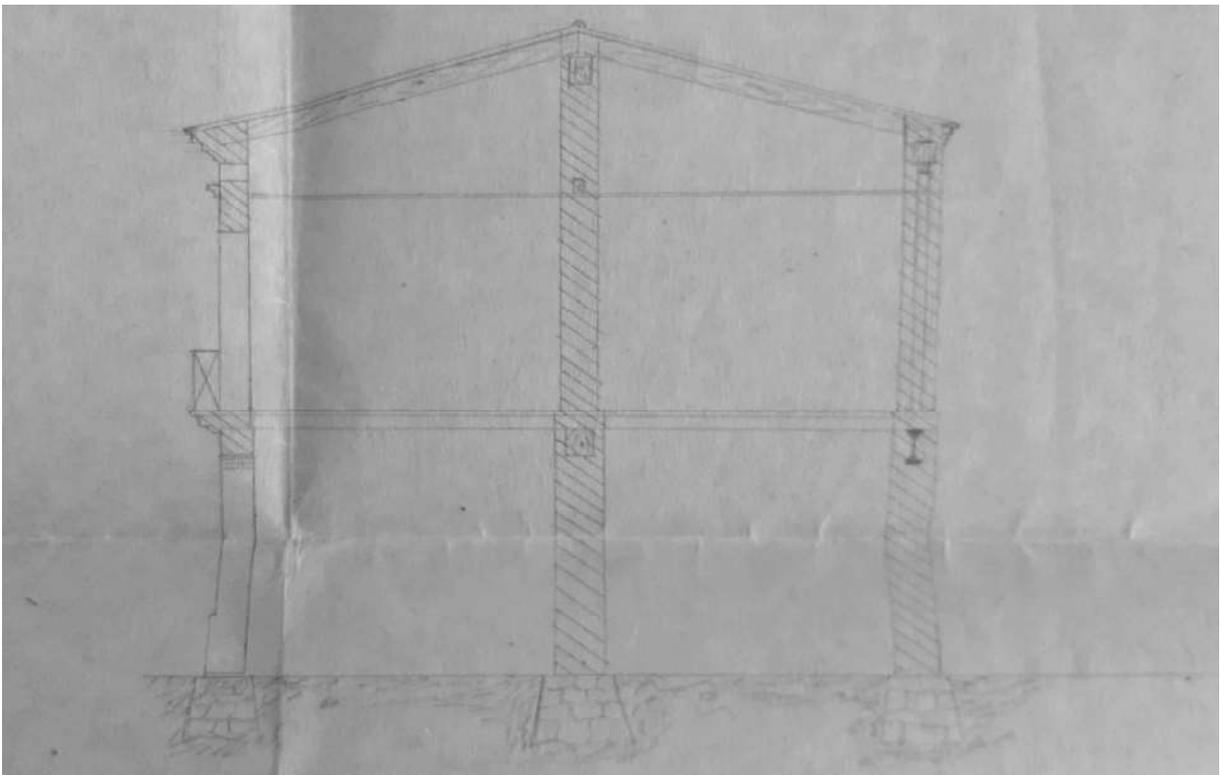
Sección edificio con detalle cimentación (1917). (Fondo Sandro Pons Romani)
